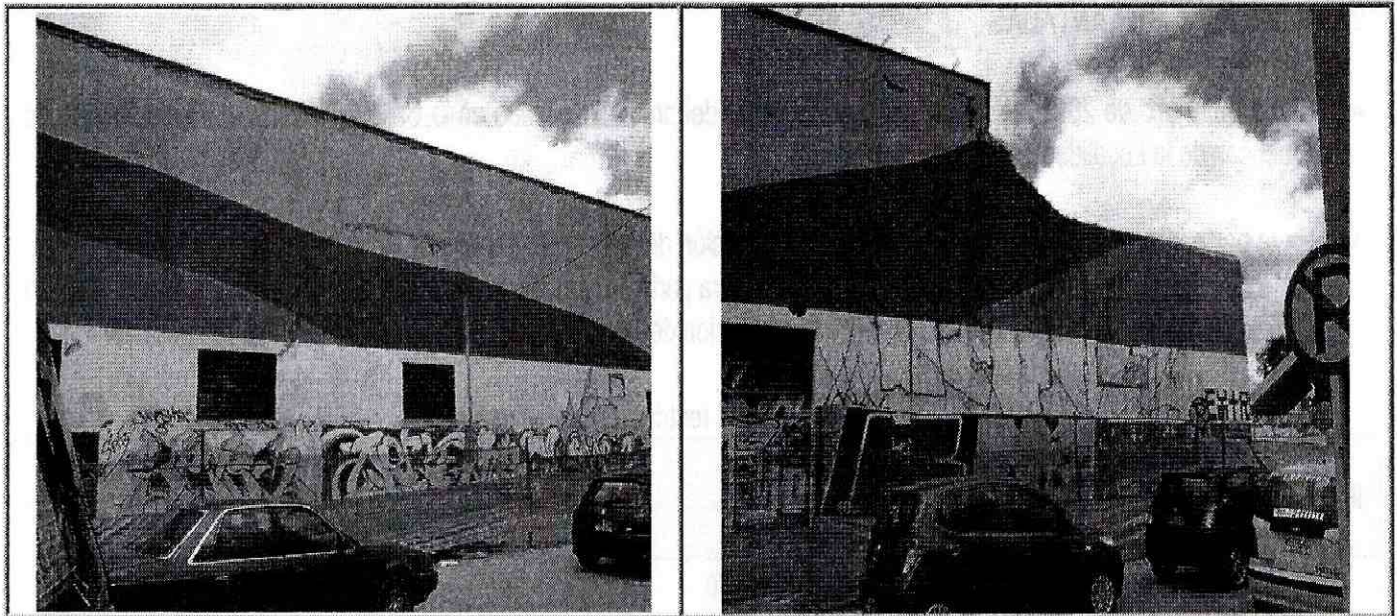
y 8. Se observa la cubierta a media altura del muro evaluado, apoyada sobre estructura en madera.
